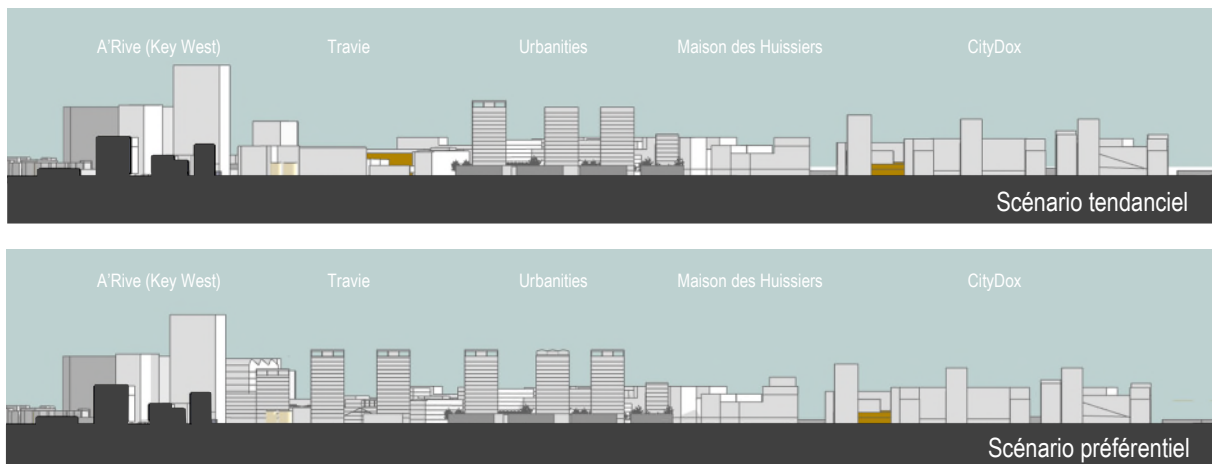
Coupe longitudinale le long du Canal : vue de la rive droite (BUUR, 2024)
